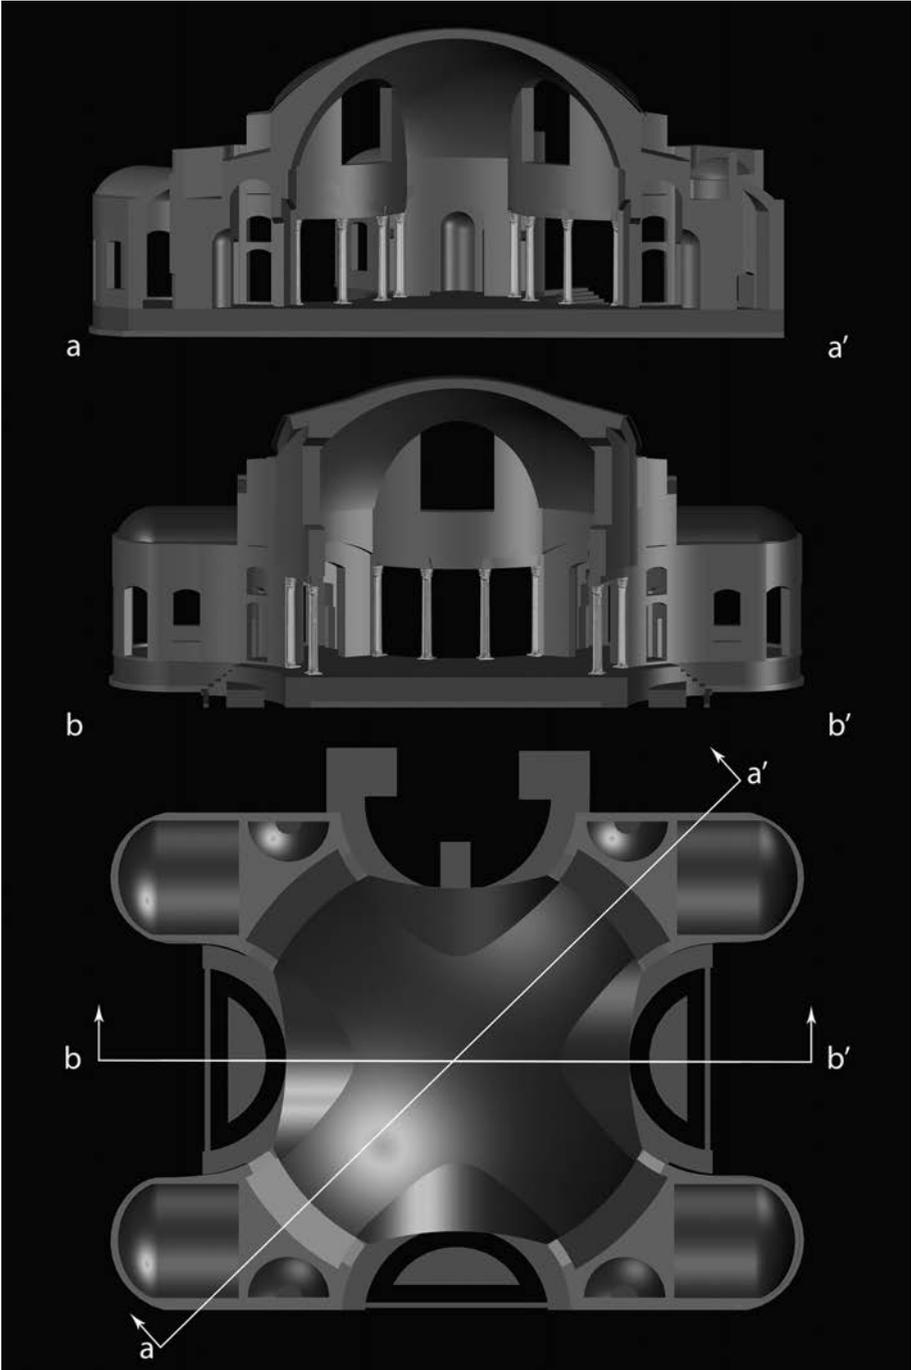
Villa Adriana, Accademia, Atrio Mistilineo, pianta e sezioni (autore).
